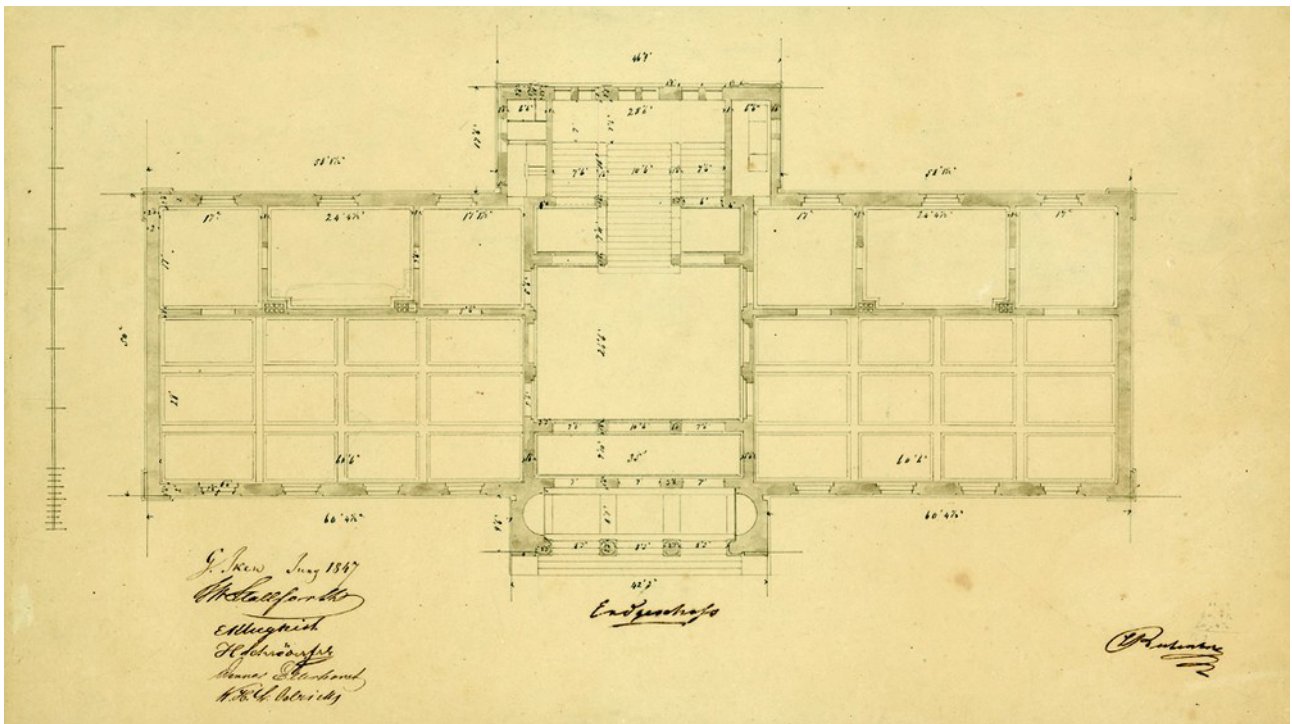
Lüder Rutenberg, Grundriss des Erdgeschosses der 1848 erbauten Kunsthalle Bremen, links und rechts des Einganges (Süden) befinden sich die zwei großen (Referenz-)Säle, A KH Bremen
